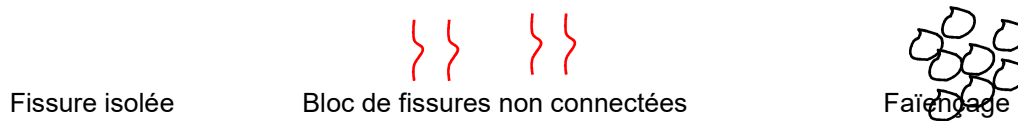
Différents chemins de fissuration (vue en plan)
